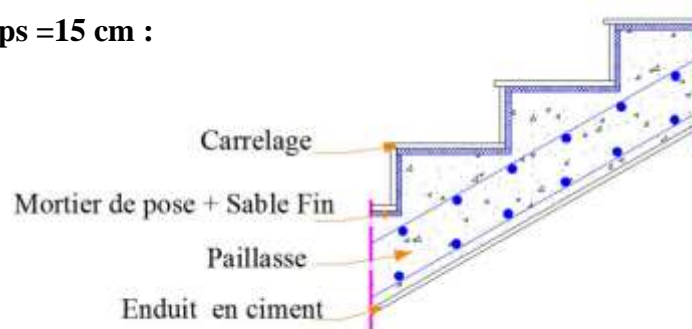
Coupe verticale de Paillasse (Dalle pleine)
